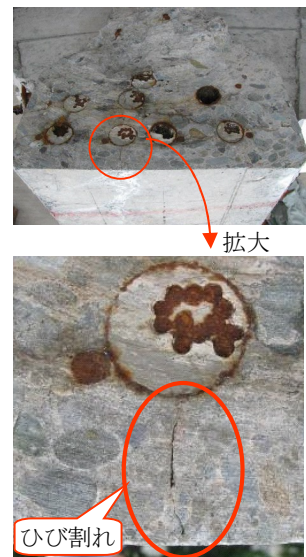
桁下面の縦ひび割れ発生状況 (G2桁支間中央付近)
